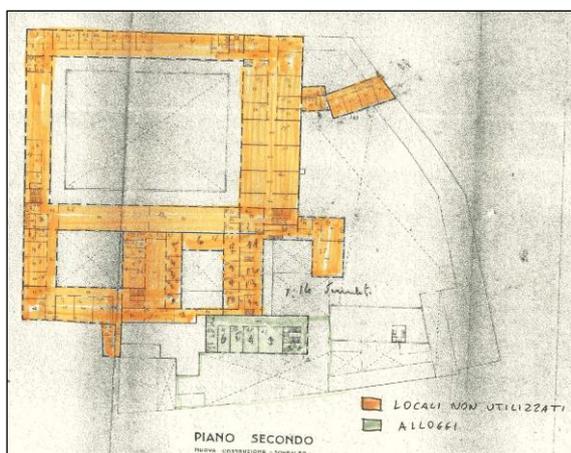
Min. Difesa - *Inventario* – Planimetria del piano secondo (1939-1944)
